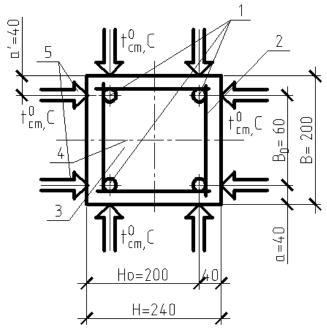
Расчетная схема поперечного сечения верхнего пояса фермы к определению проектной огнестойкости:
